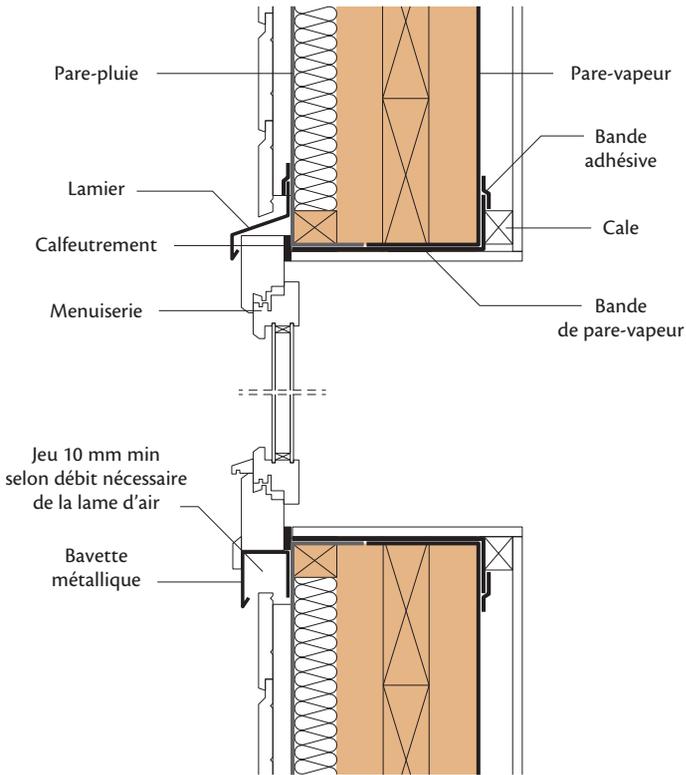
Exemple de mise en œuvre de menuiserie en applique extérieure, coupe verticale
